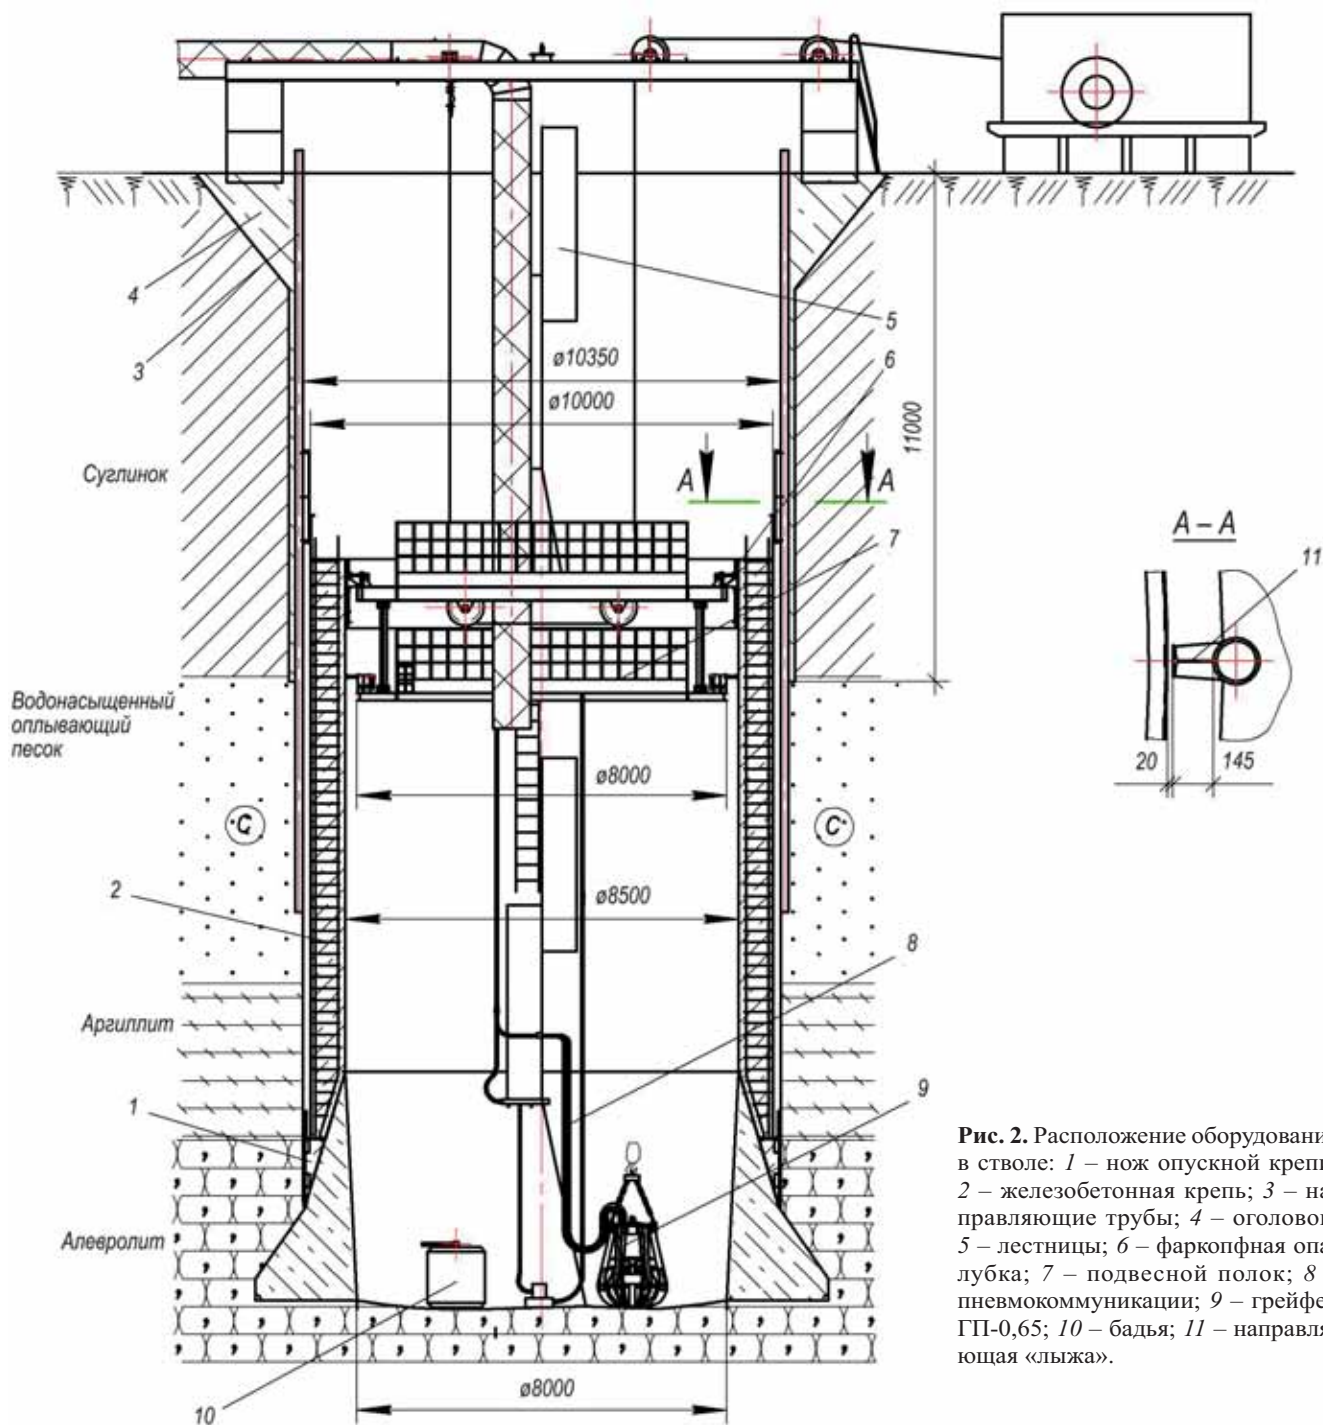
Расположение оборудования в стволе: 1 – нож опускной крепи; 2 – железобетонная крепь; 3 – направляющие трубы; 4 – оголовок; 5 – лестницы; 6 – фаркопная опалубка; 7 – подвесной полок; 8 – пневмокоммуникации; 9 – рейфер ГП-0,65; 10 – бадья; 11 – направляющая «лыжа».
